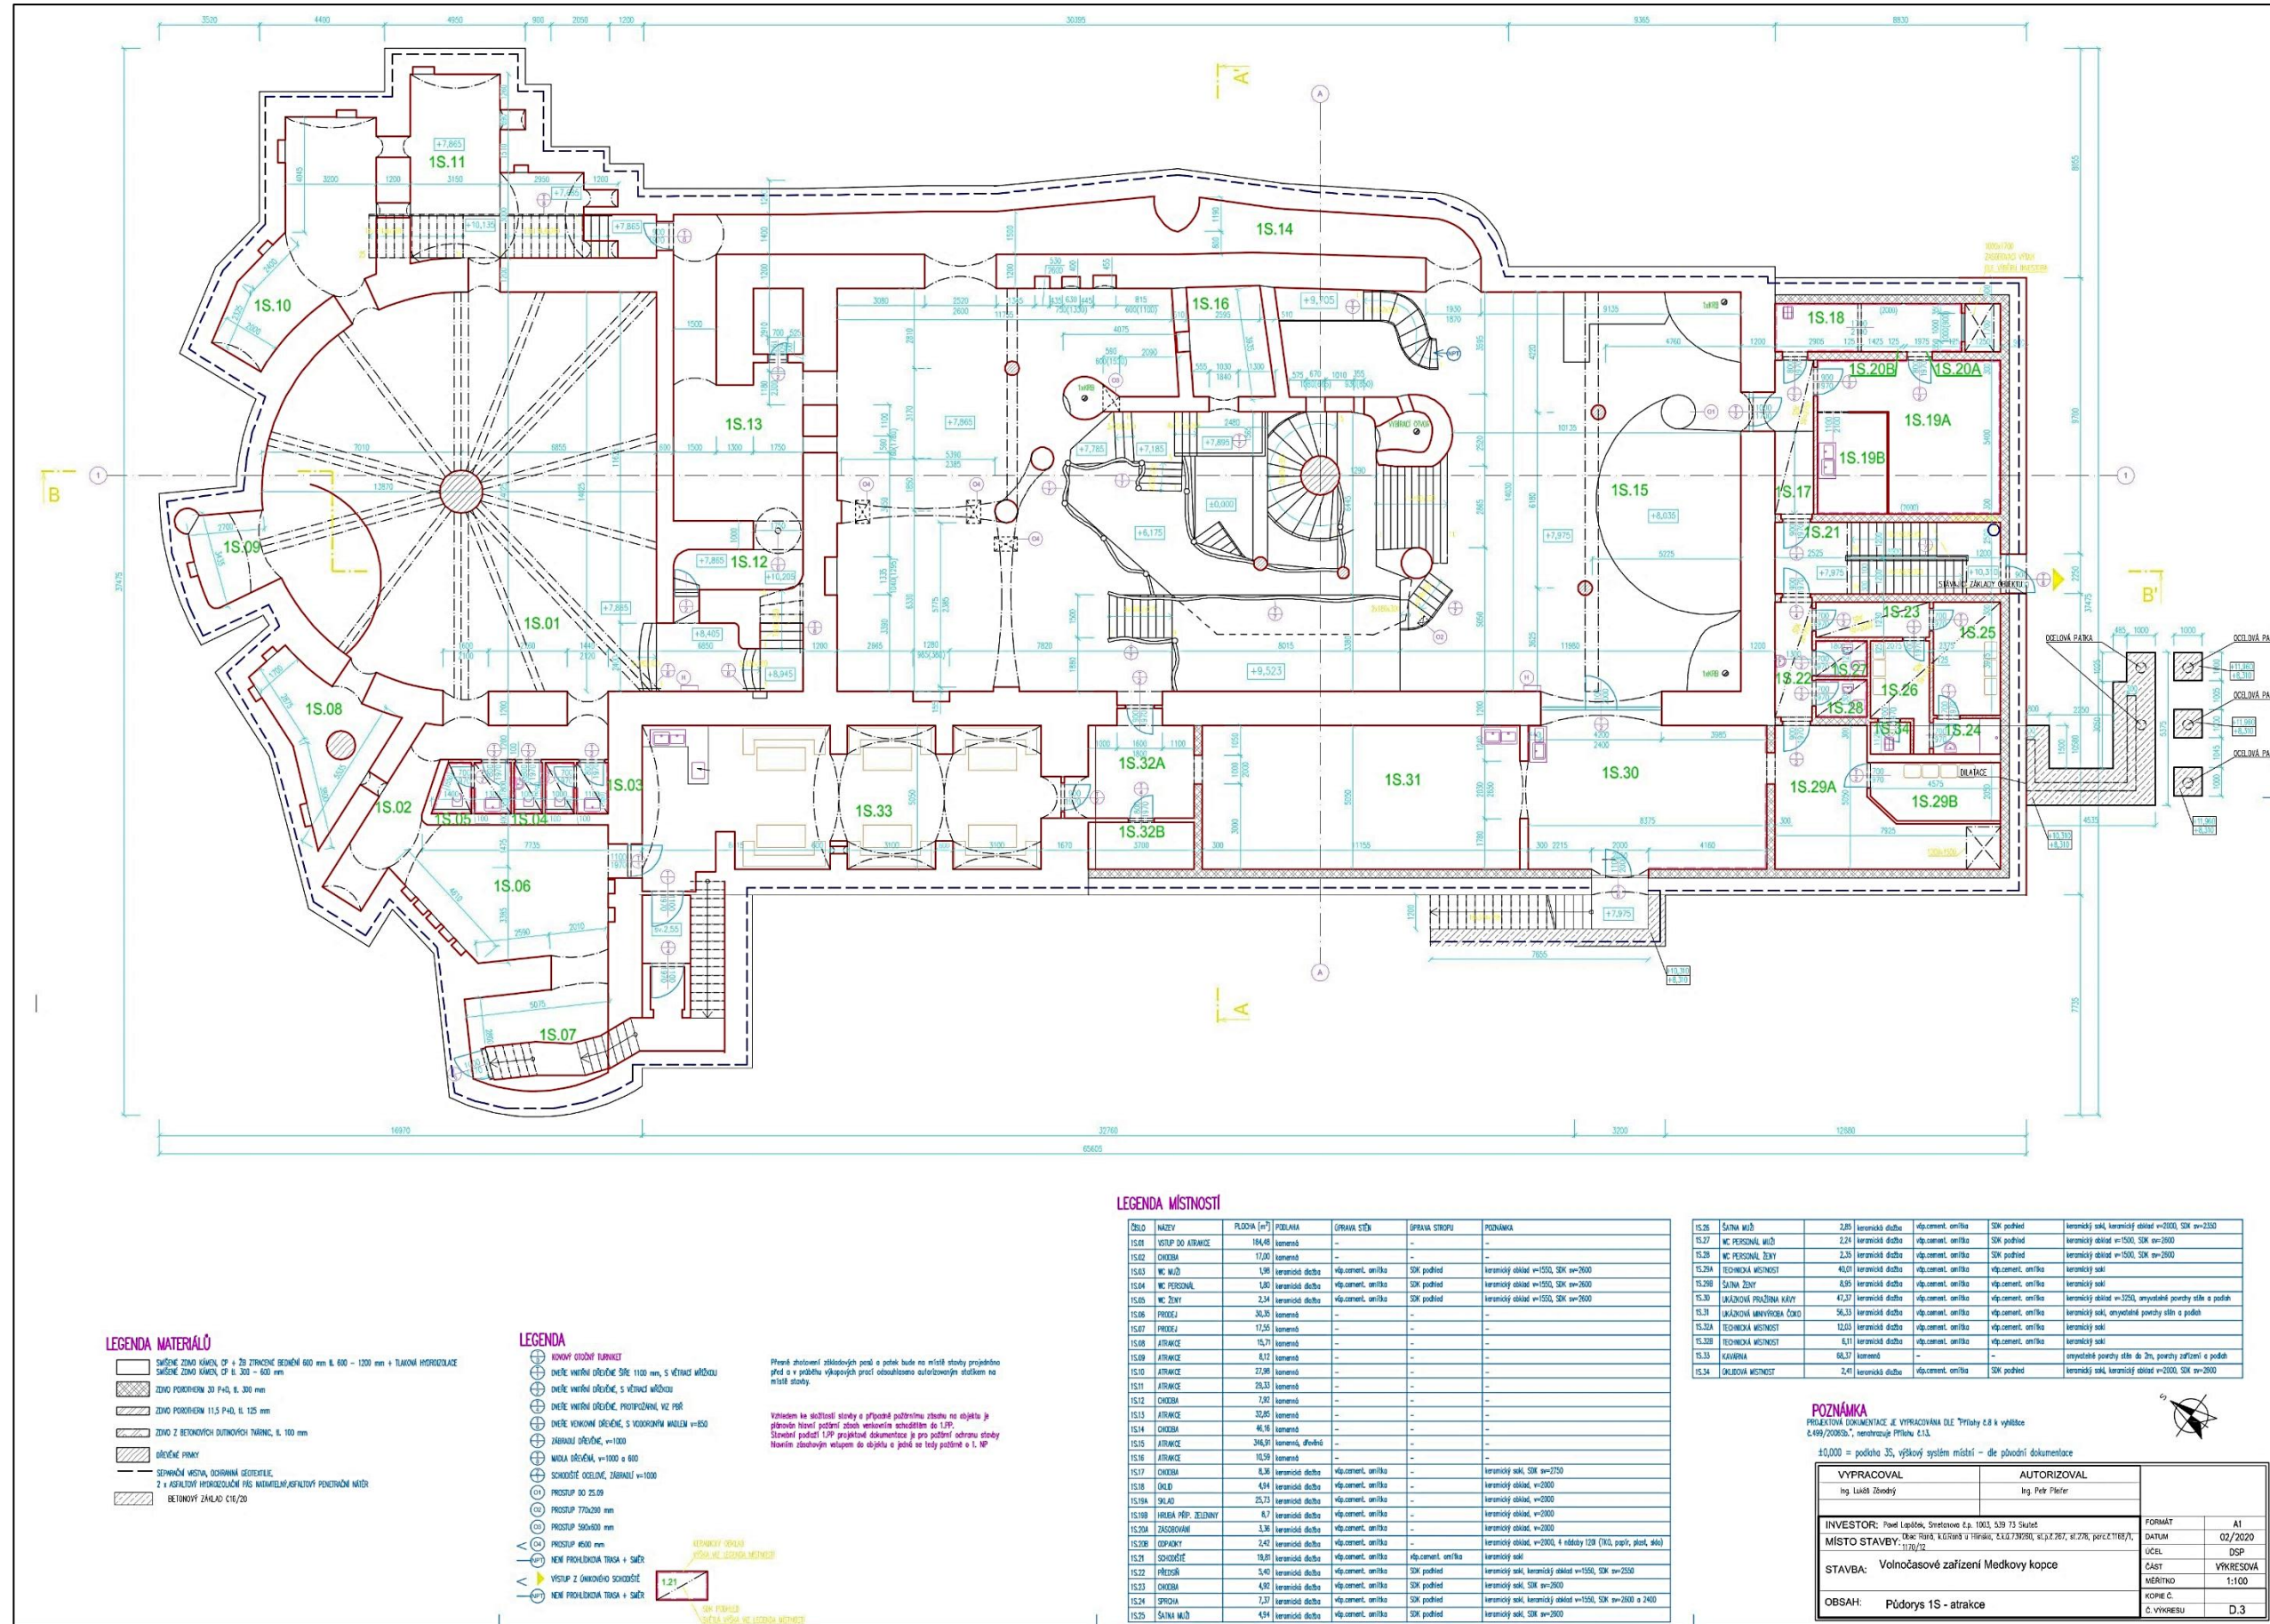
Půdorys 1NP tematického objektu Pekla s restaurací
